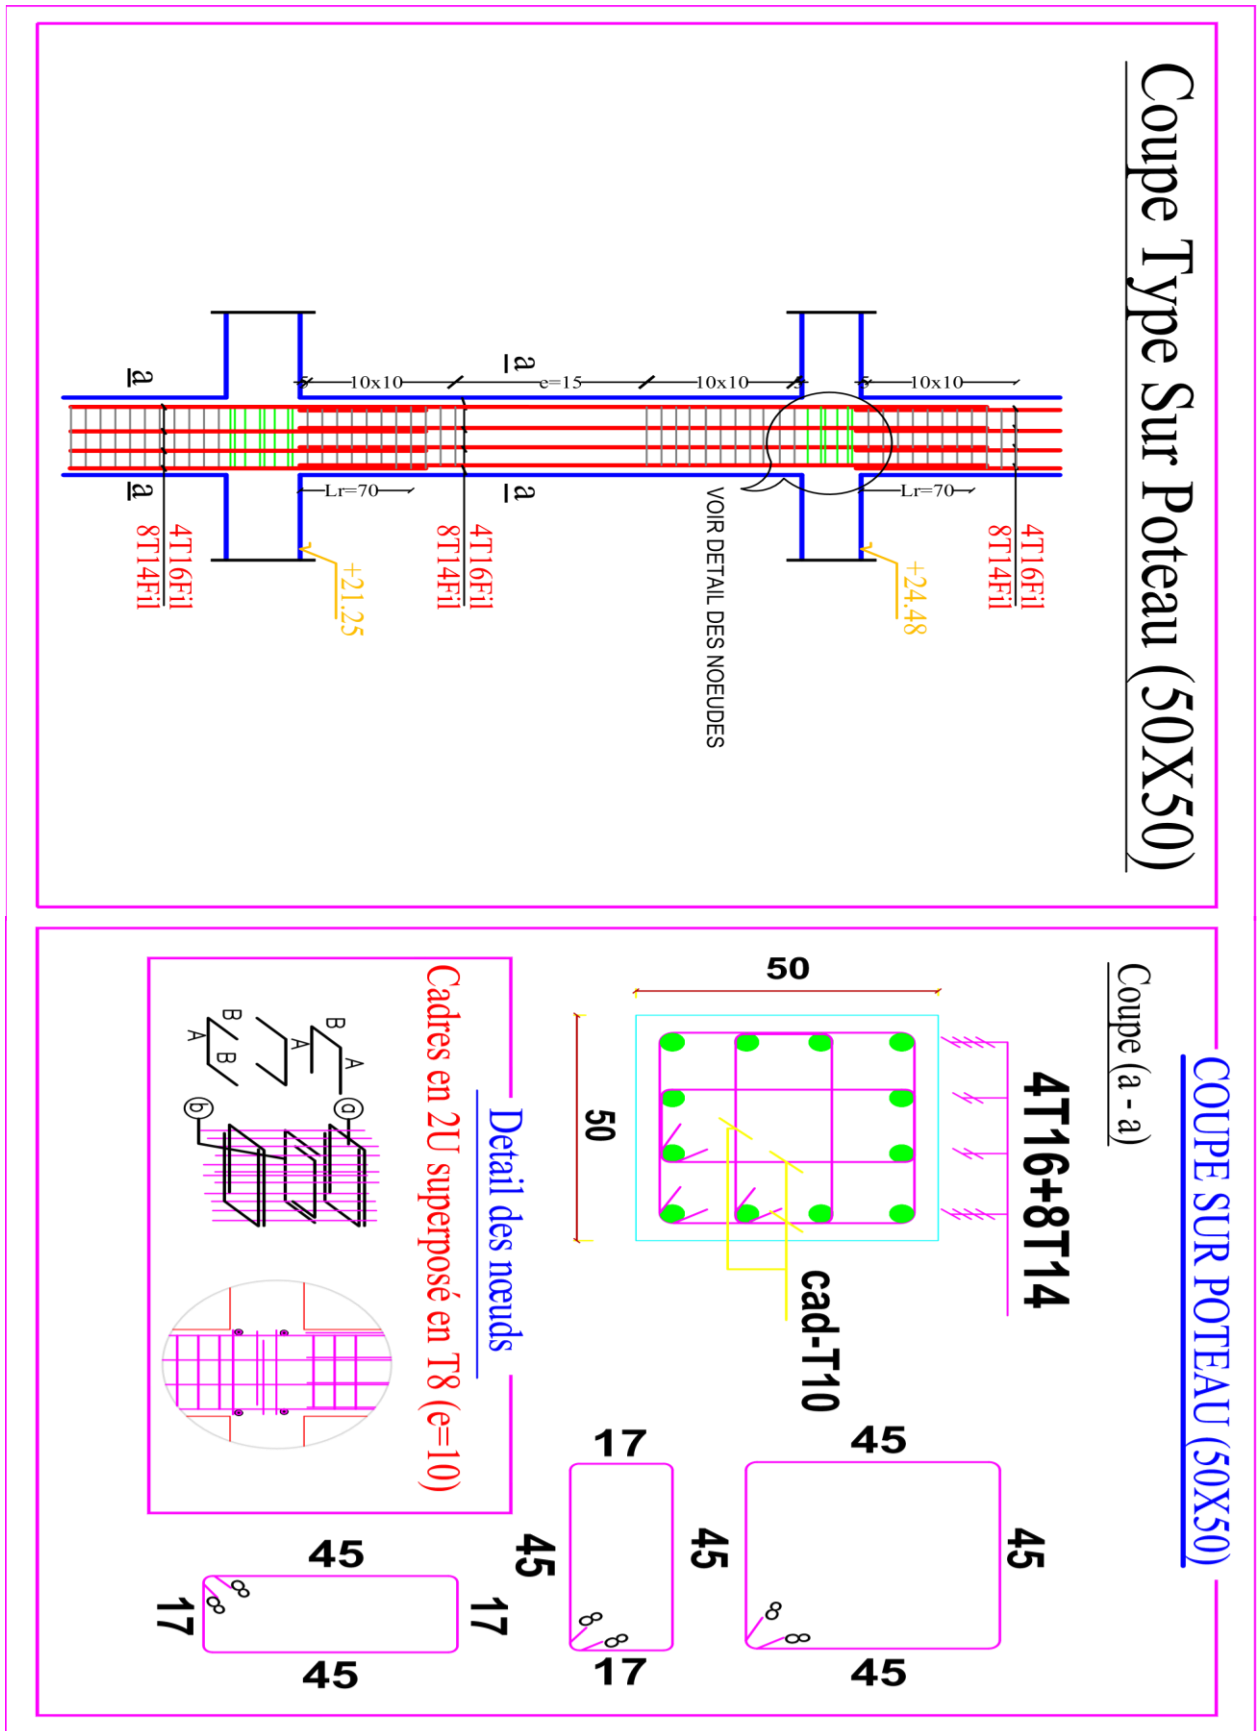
Schéma de ferrailage des poteaux (50x50)
